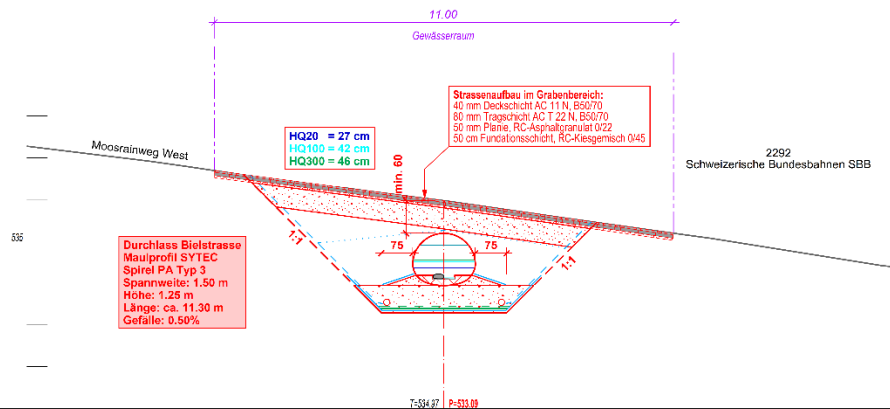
Ausschnitt Normalprofil Stand Wasserbauplan, 26.07.2024
